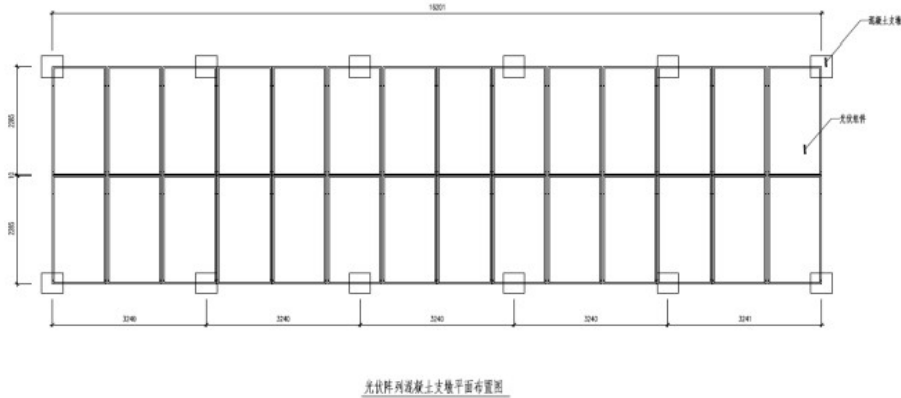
钢筋混凝土结构屋面光伏组件支架系统示意图
